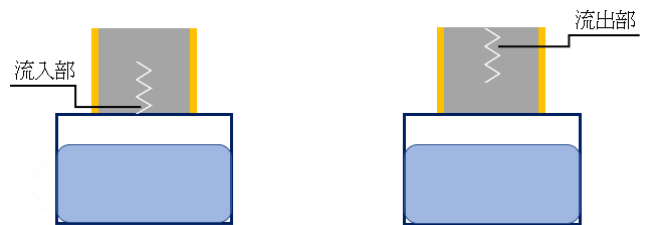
ひび割れの位置(流入部) 図-2 ひび割れの位置(流出部)
